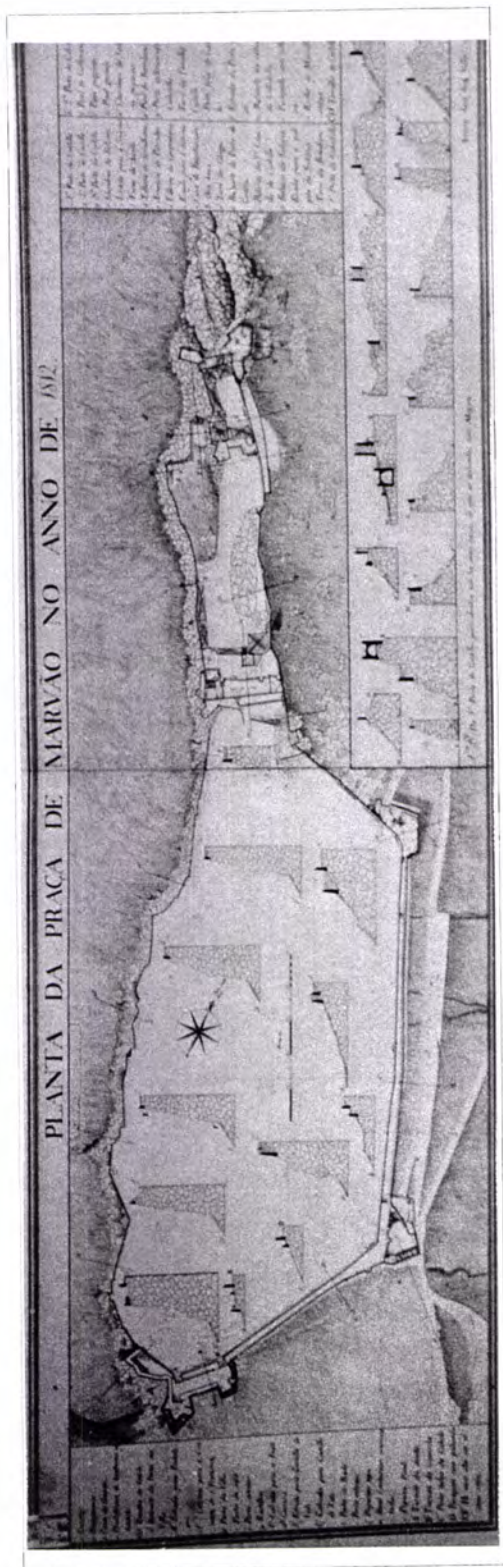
Planta da Praça de Marvão (1812). Pormenor ampliado da zona do Castelo.
